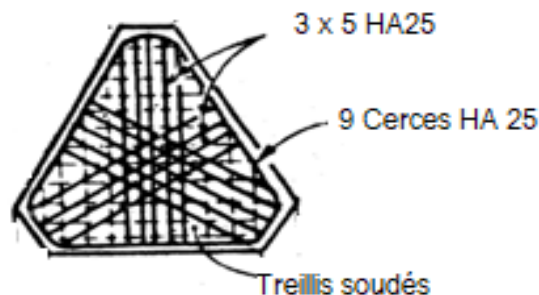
Vue en plan du schéma de ferrailage de la semelle sur 3 pieux
